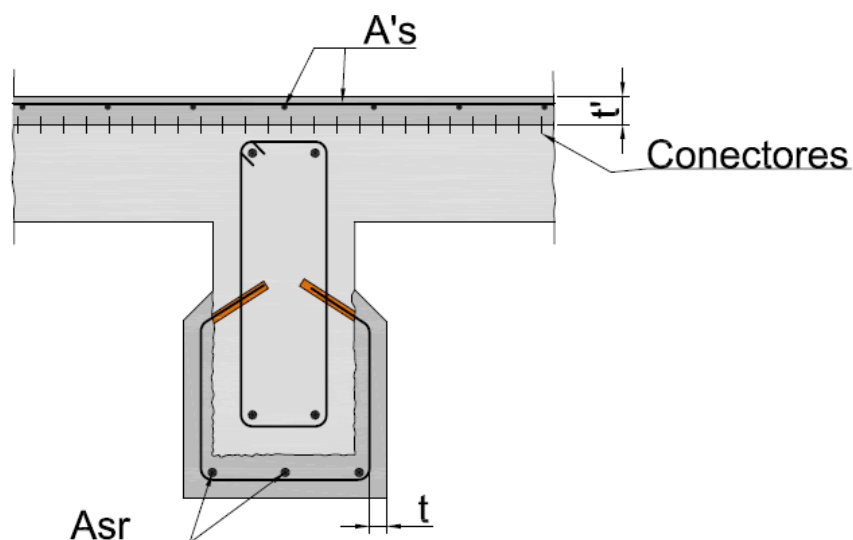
Reforço à flexão de viga e laje, adaptado de [29].
